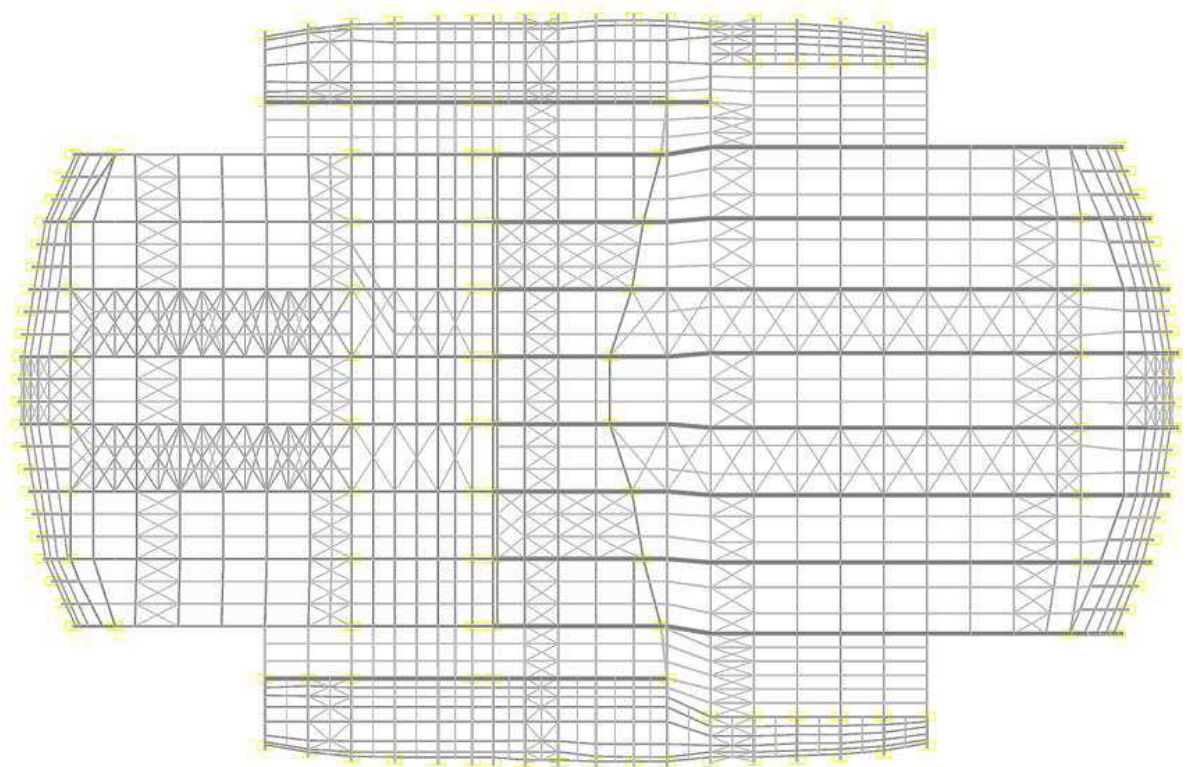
Расчетная схема покрытия (вид сверху) с учетом типов поперечных сечений
